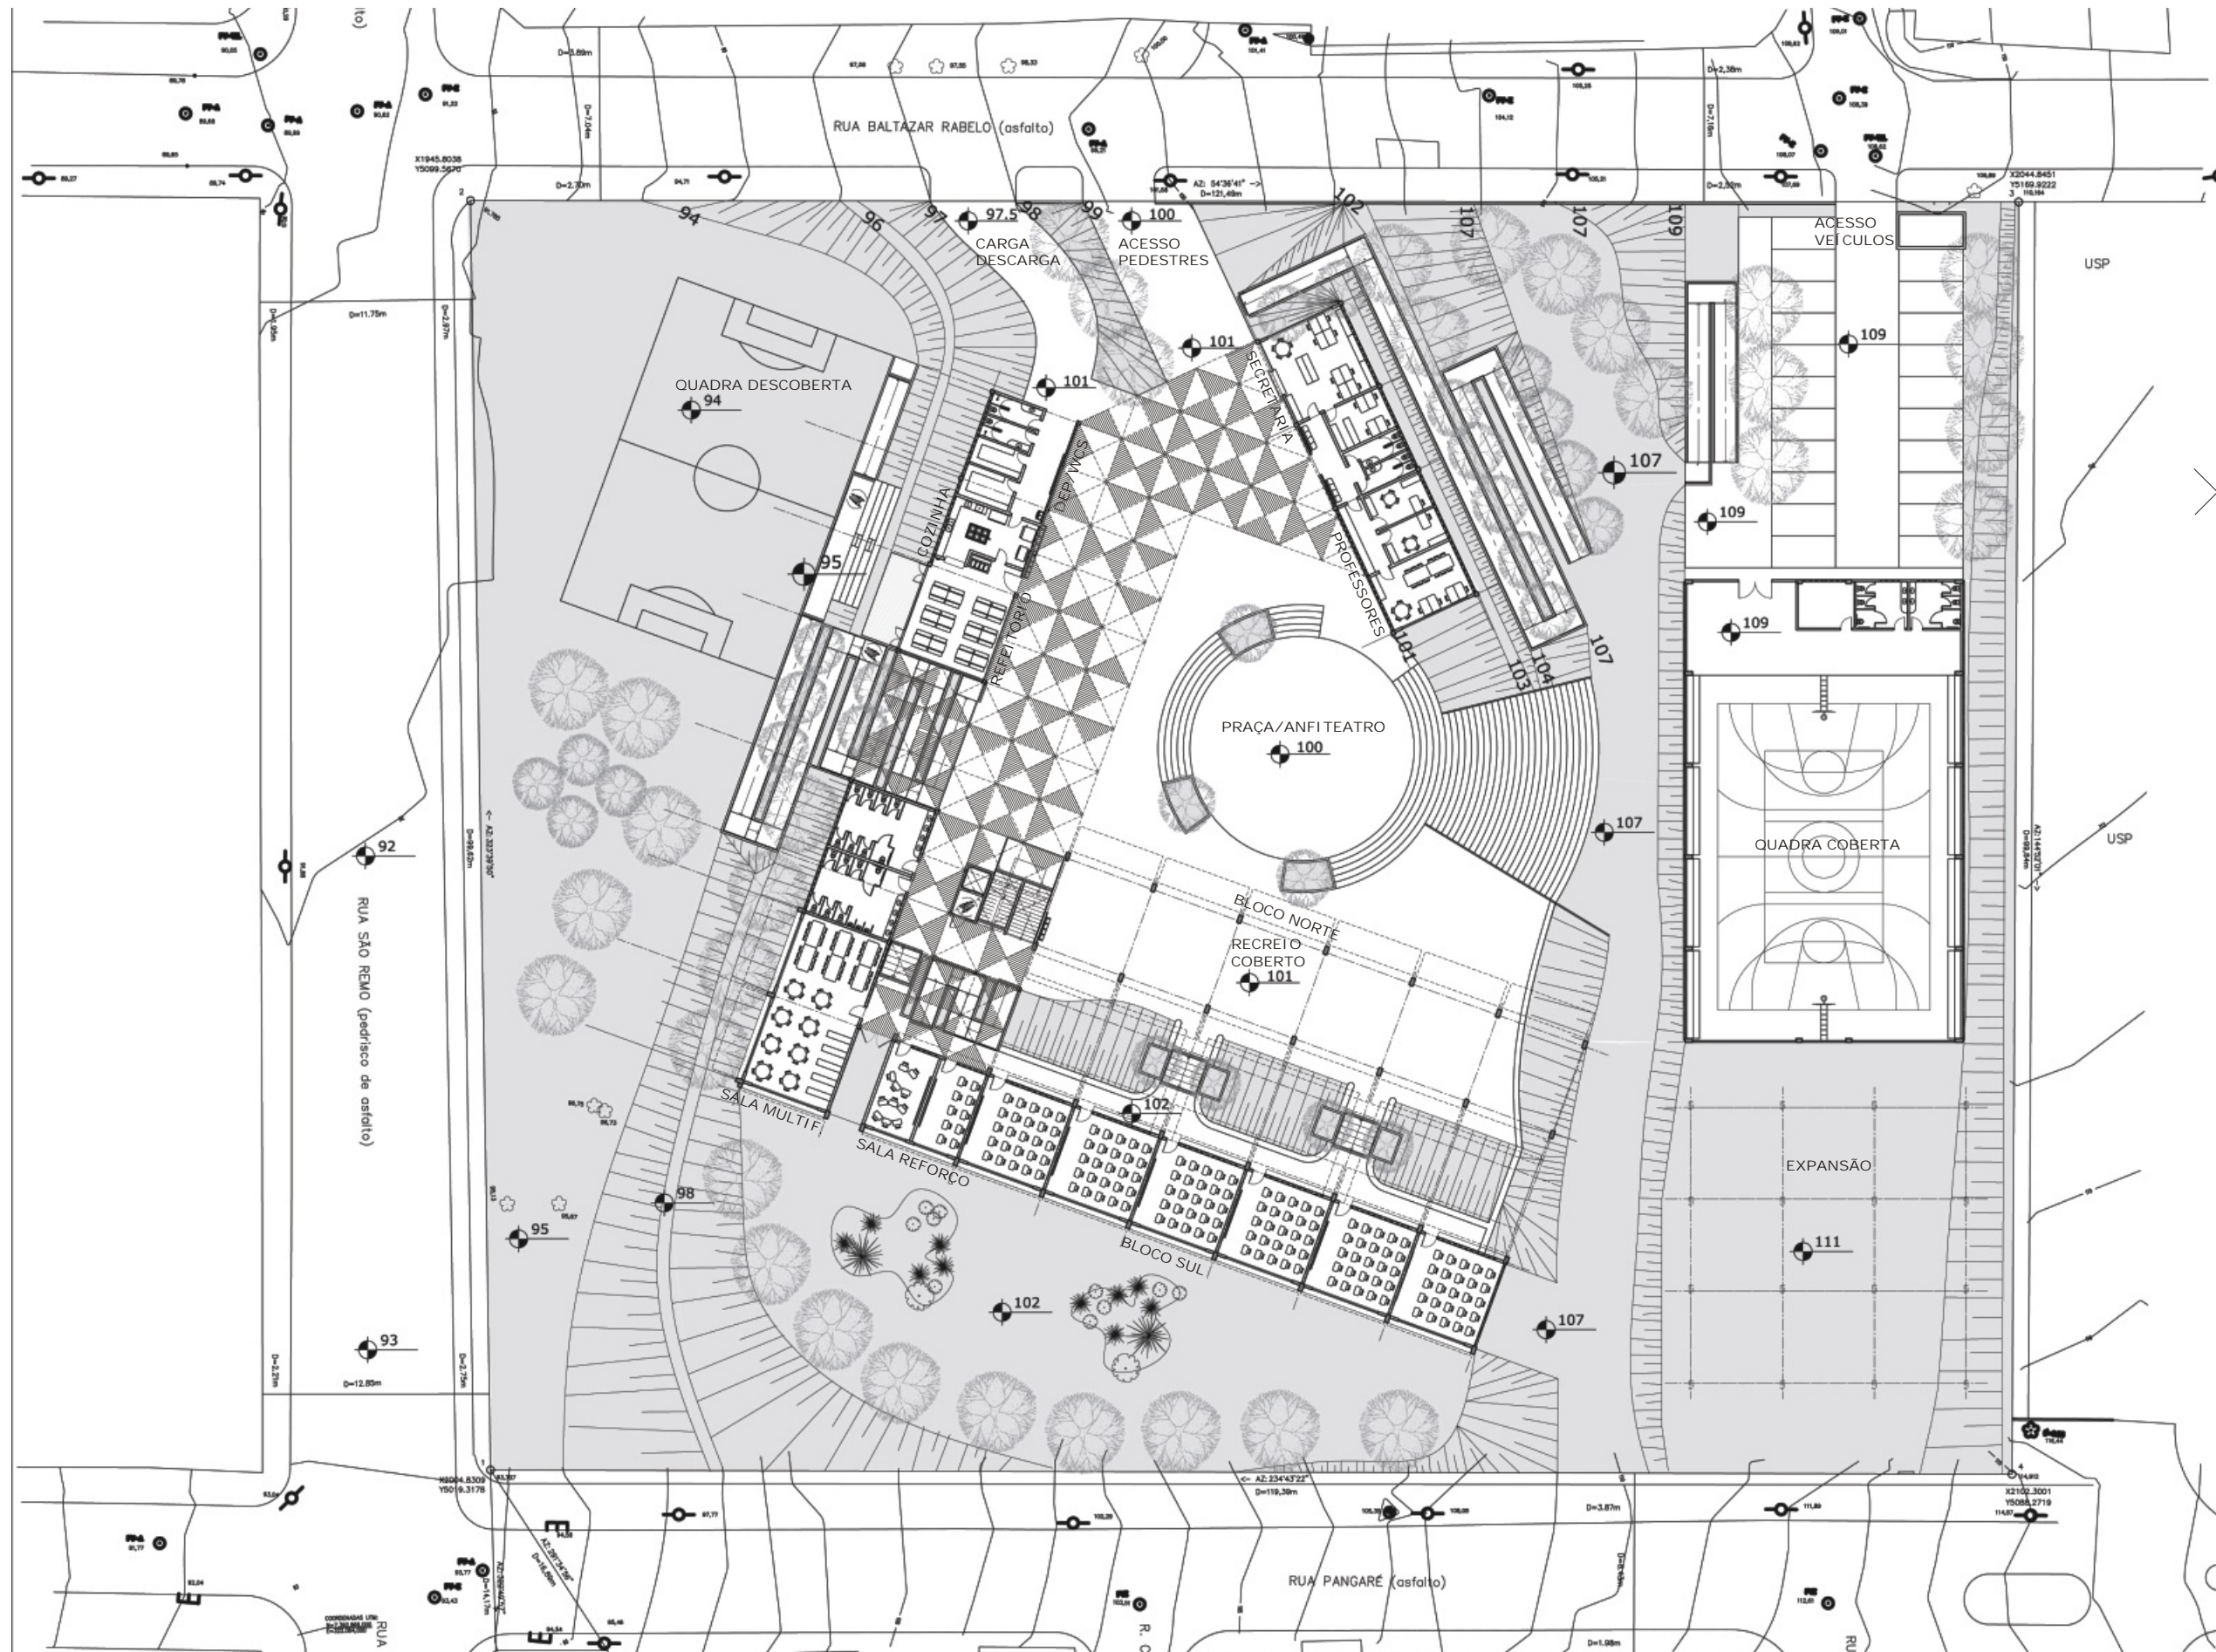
Implantação do conjunto; planta baixa dos edifícios
